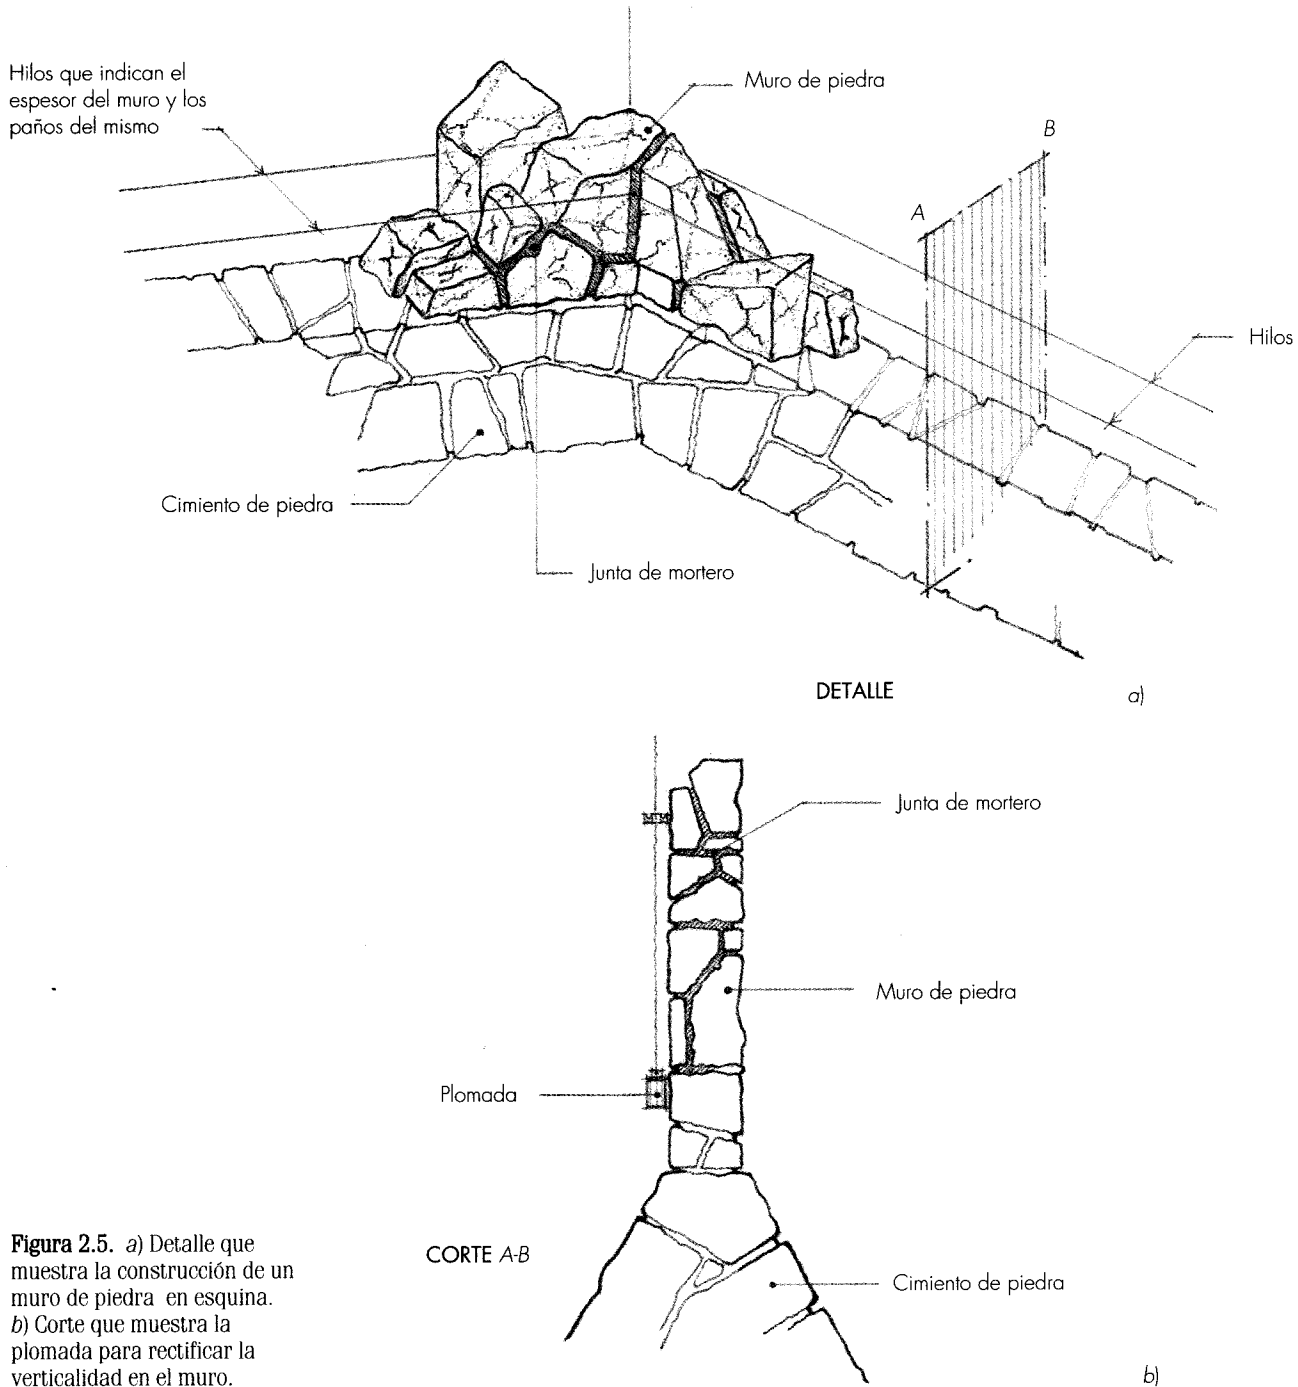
a) Detalle que muestra la construcción de un muro de piedra en esquina. b) Corte que muestra la plomada para rectificar la verticalidad en el muro.
